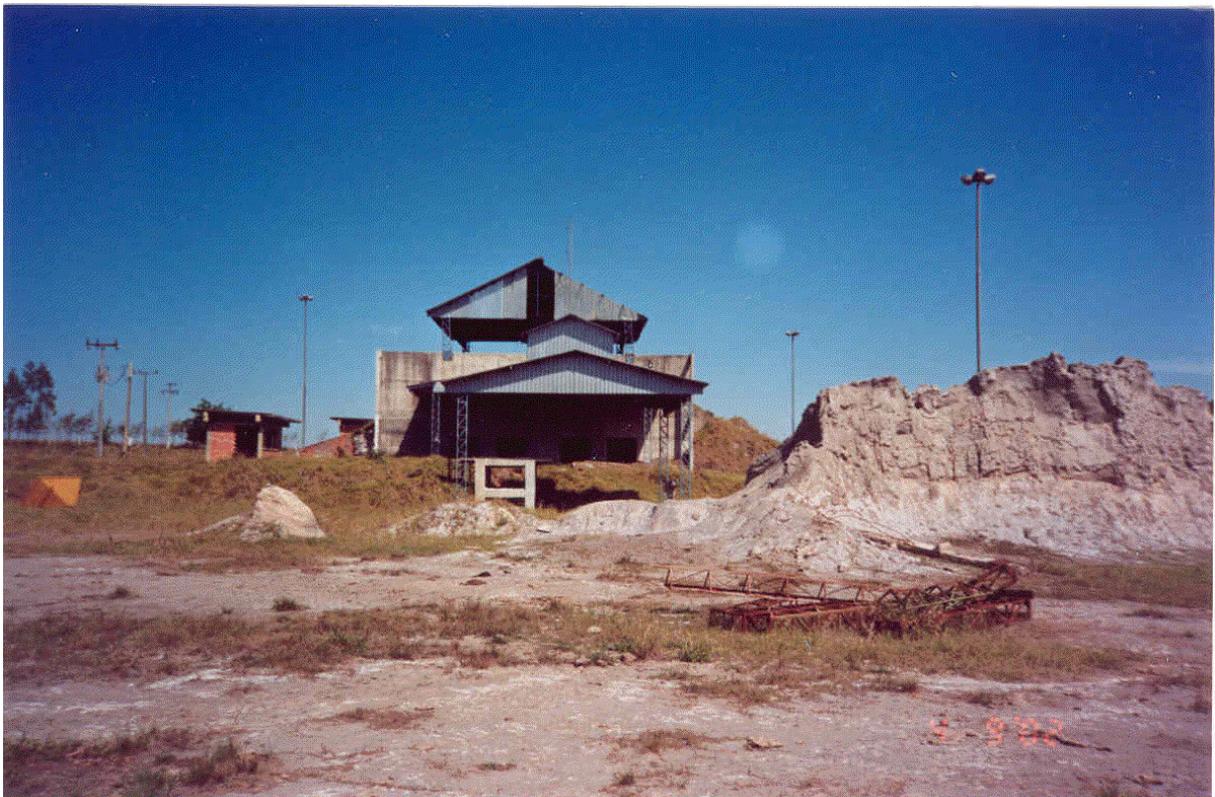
Vista da infraestrutura de moagem e britagem, da mina de calcário.
